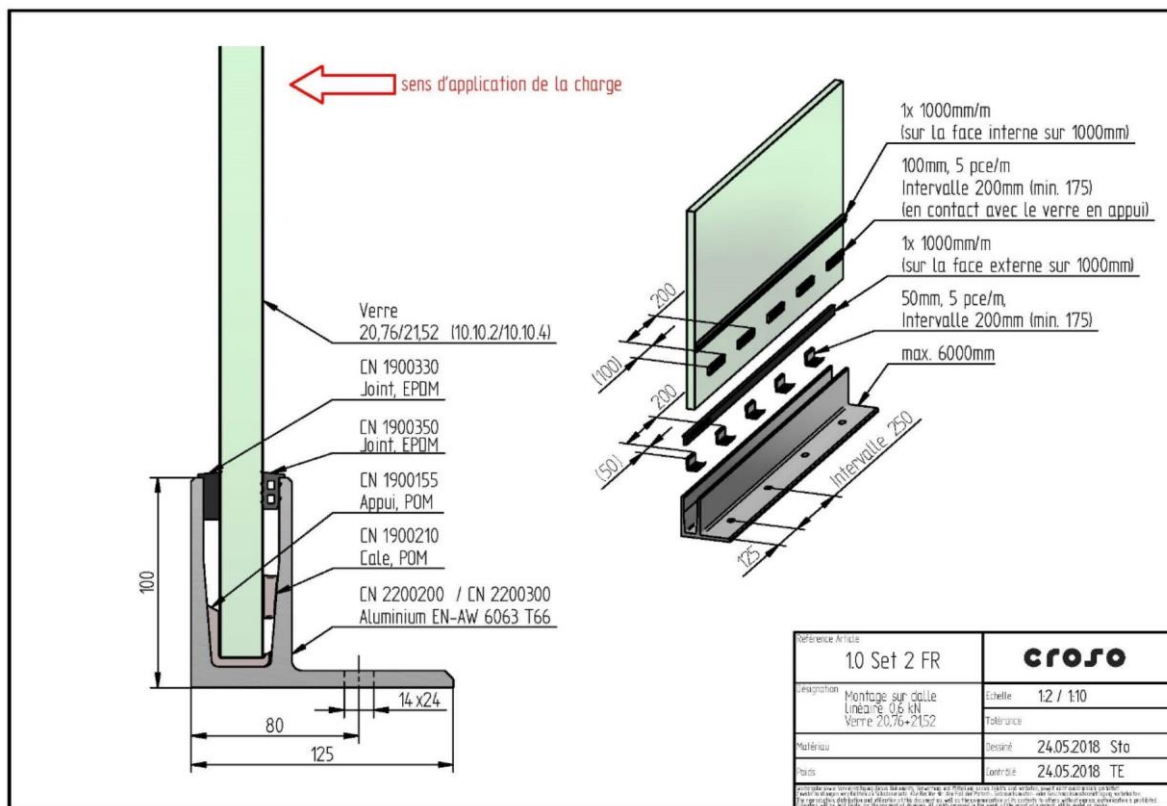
CROSILUX 1.0 – Montage sur dalle – Profilé renforcé
